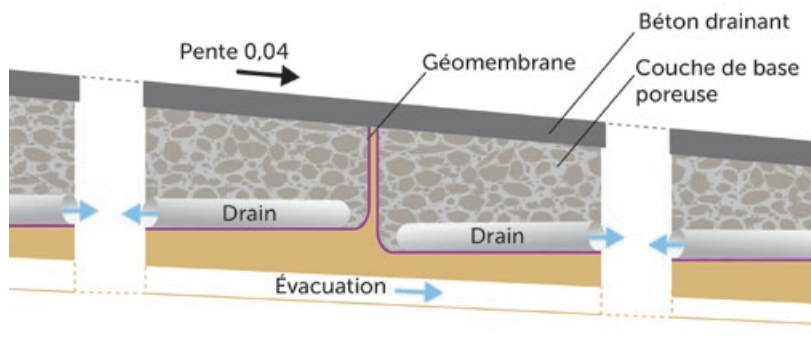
Exemple de stockage sous chaussée et trottoirs à forte pente.
